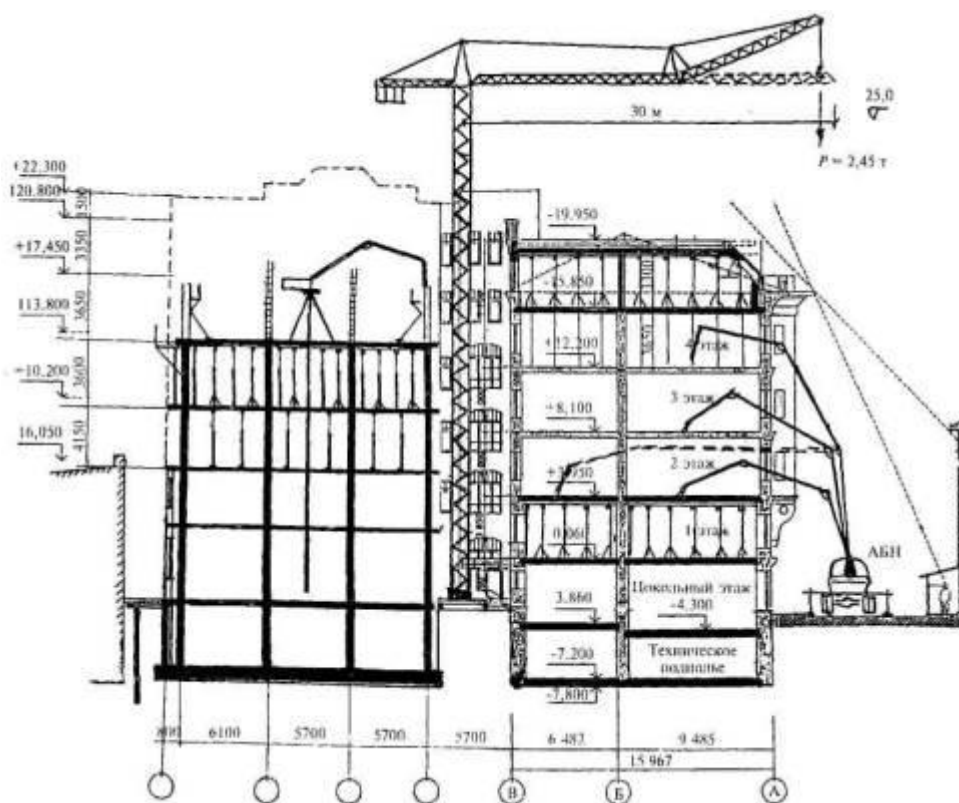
Технологические схемы производства работ по замене перекрытий, надстройке аттикового этажа и многоэтажной пристройки
